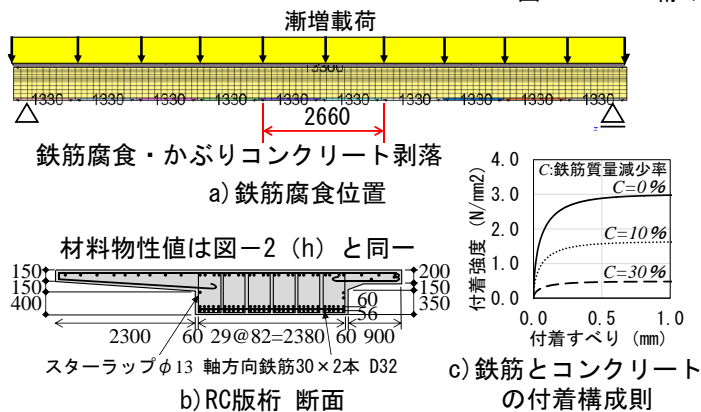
RC 版桁のモデルと腐食後の鉄筋とコンクリートの付着
